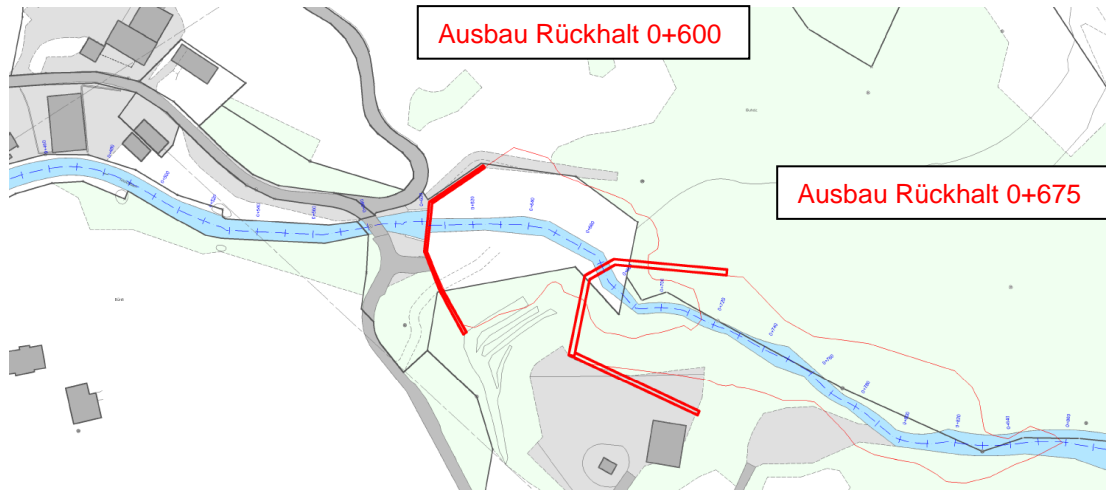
Variante 2, Ausbau bestehender Rückhalt 0+600, Neubau Rückhalt 0+675
